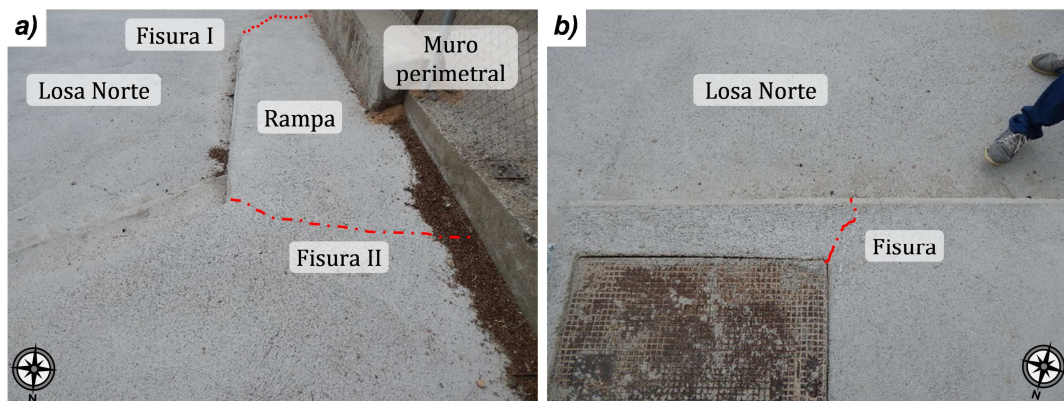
74 – Losa Norte superior; a) fisuras en la rampa; b) fisuras a 45°
